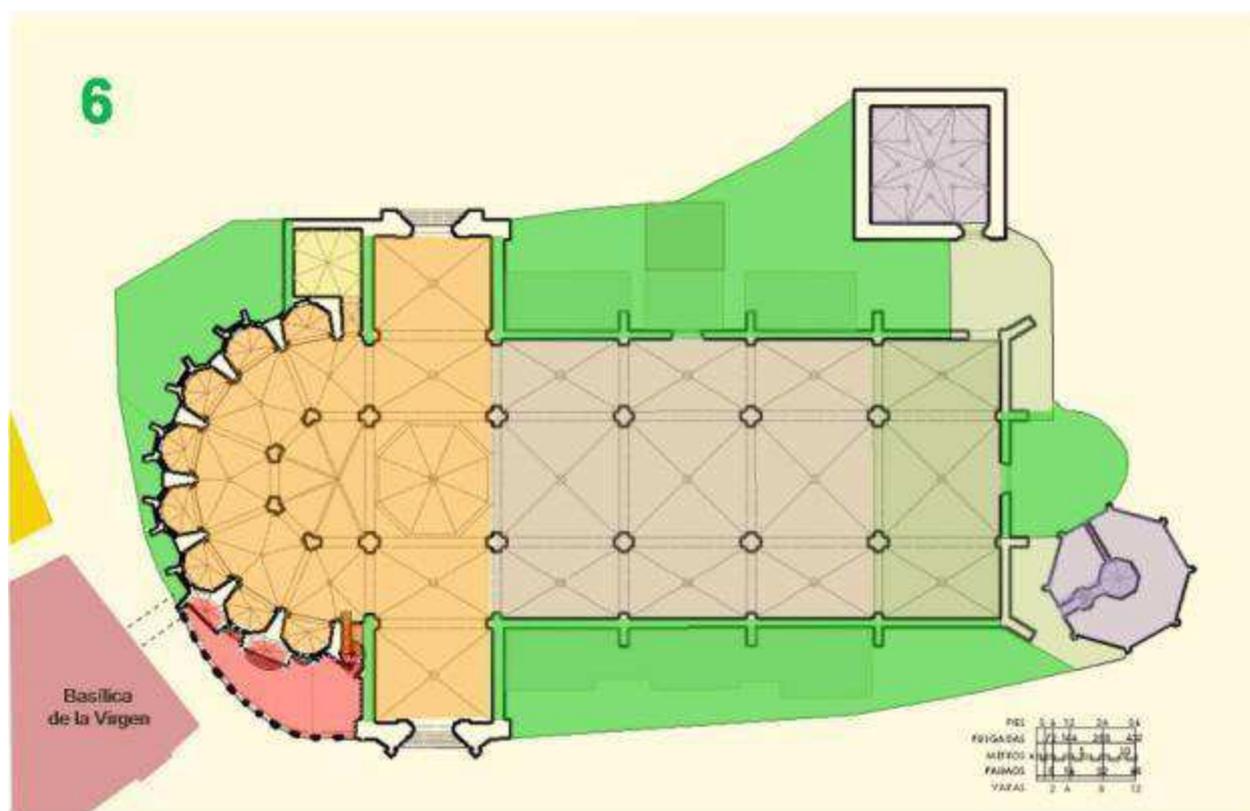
12.6 Evolución constructiva. Fase 6 / Planta <sup>326</sup>
